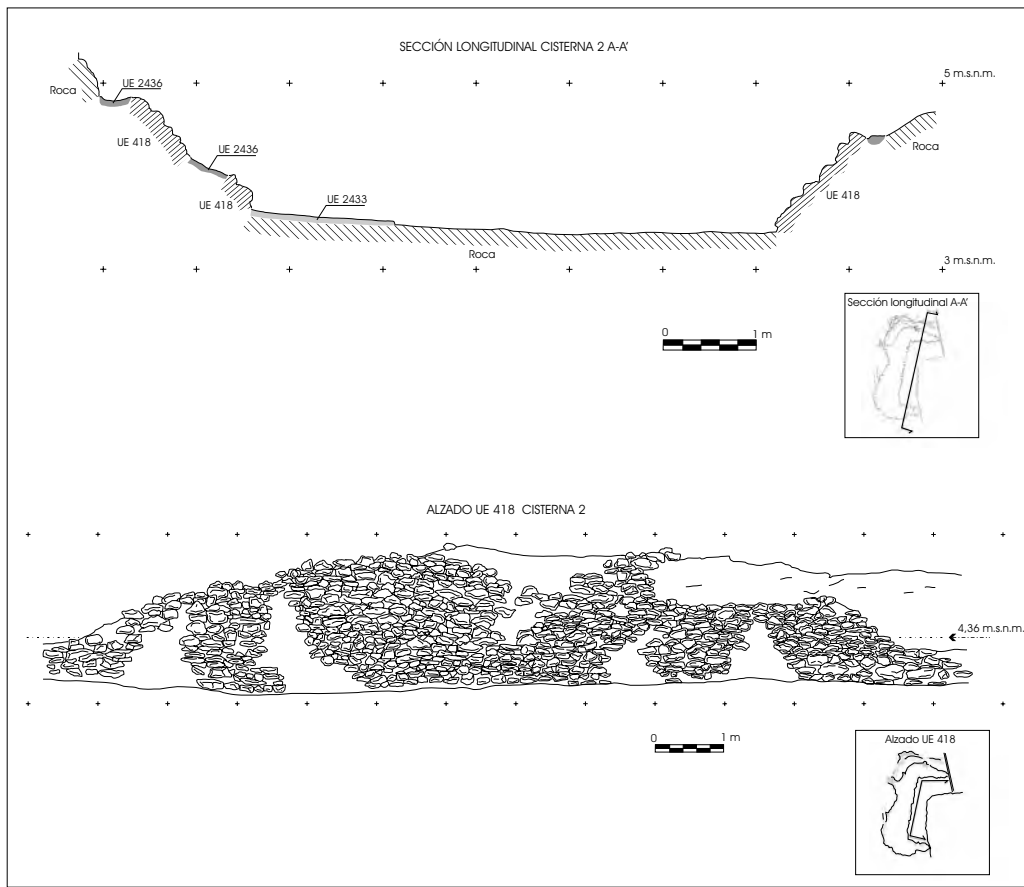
Sección longitudinal y alzado del recubrimiento de mampostería de la cisterna nº 2. 2002
